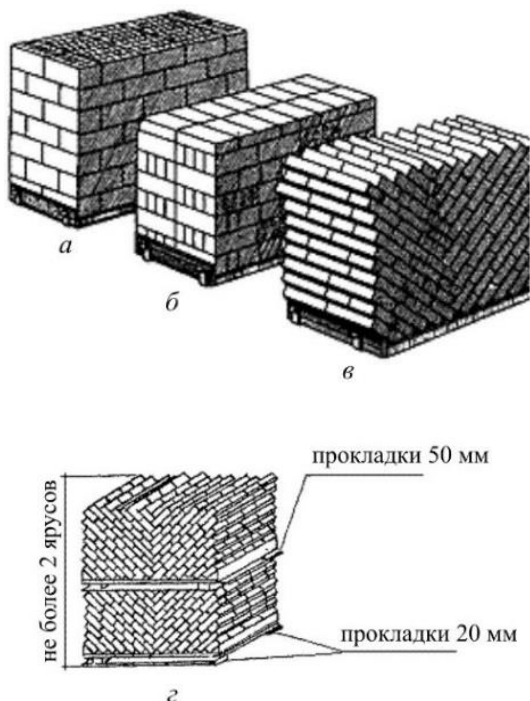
Укладка на поддонах кирпича с перевязкой:
